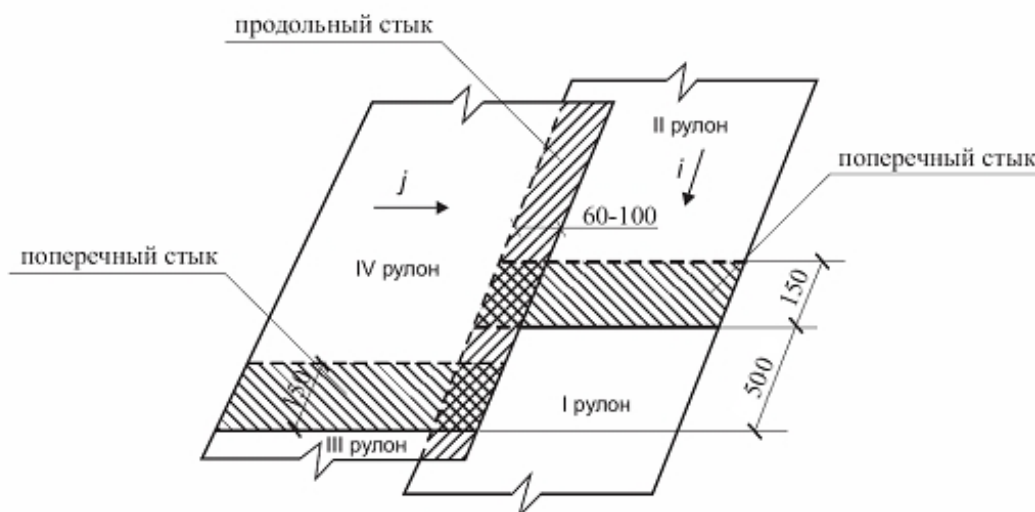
Соединение полотен рулонного наплавляемого материала
